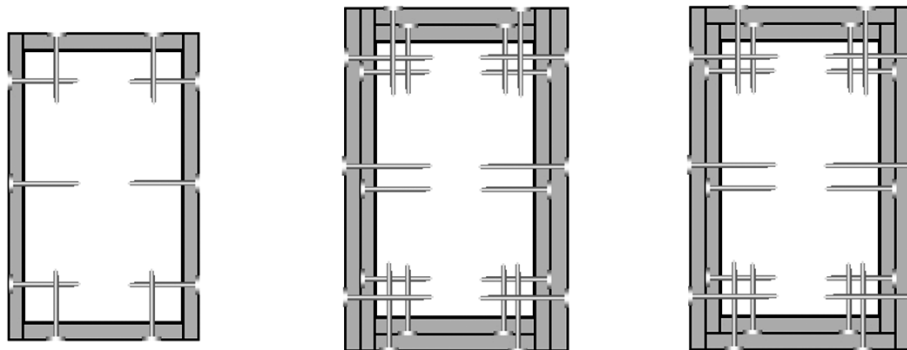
Proteção da madeira por material isolante por cobrimento em pilares e vigas, exemplos de fixação (Fonte: Eurocode 5, 2004)
